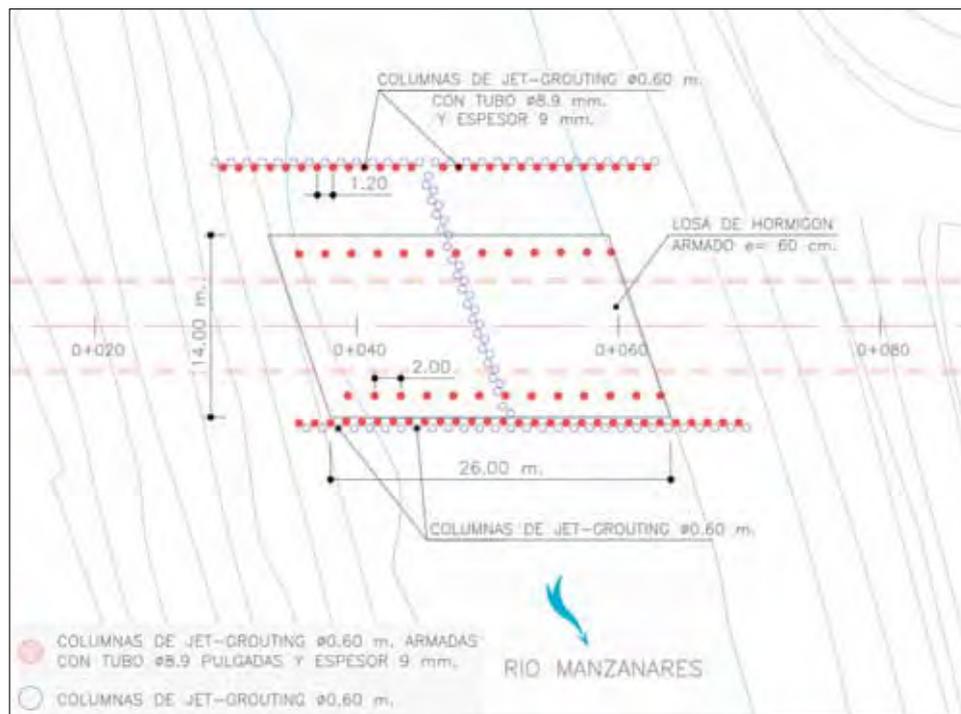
Cruce del río Manzanares y construcción de la losa superior de hormigón armado
